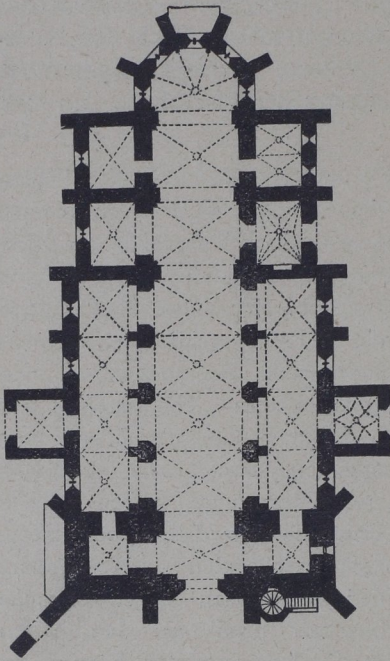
Grundriss der Stadtkirche in Nürnberg.
